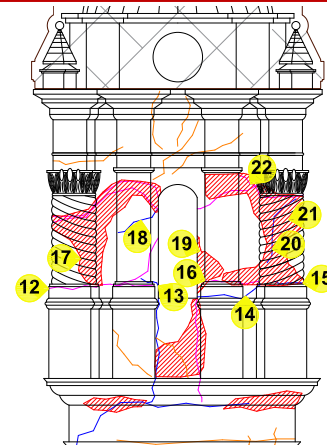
Detalle de deterioros en parte baja de segundo cuerpo de torre, fachada norte
